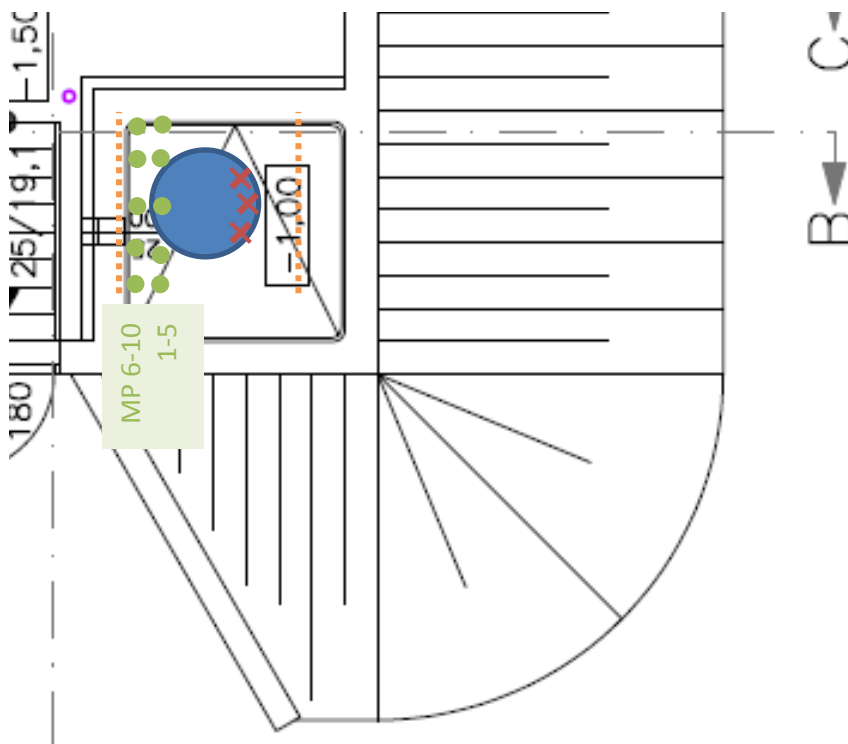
Grundrisssskizze Versuch Seibersdorf
